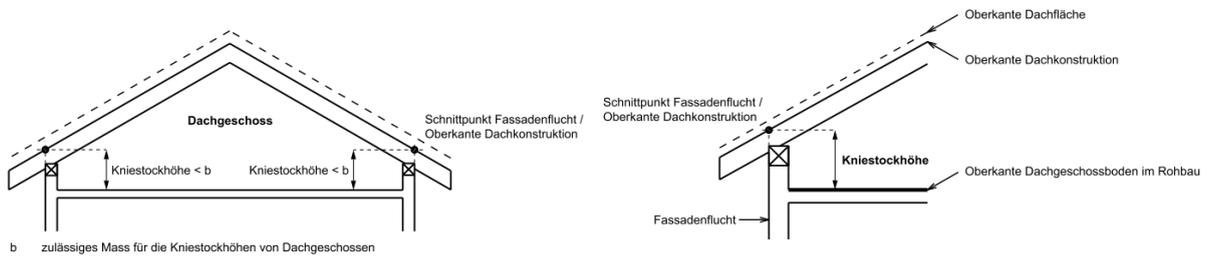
Figur 6.3 Dachgeschoss und 5.3 Kniestock, IVHB
